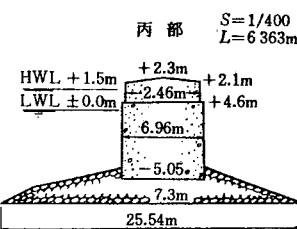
室蘭港南、北防波堤標準断面図（単位：m）
